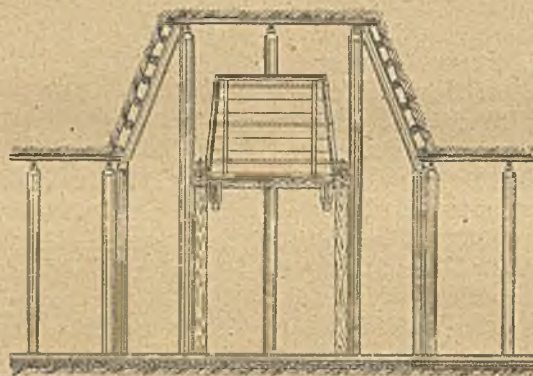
Streckenlängsschnitt mit eingebautem Gesteinstaubbruch von hoher Bauart.
